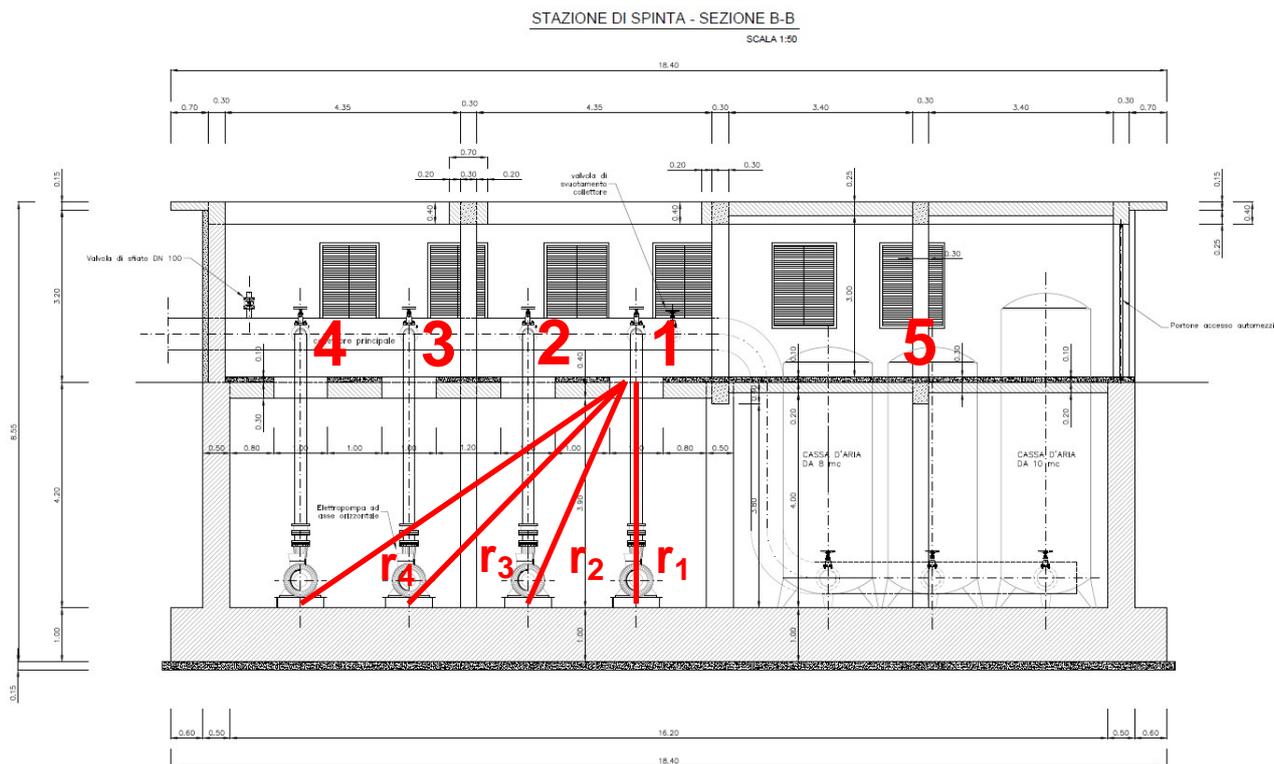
Estratto dall'Allegato 4.f al Progetto esecutivo; sezione B-B della stazione di sollevamento.
